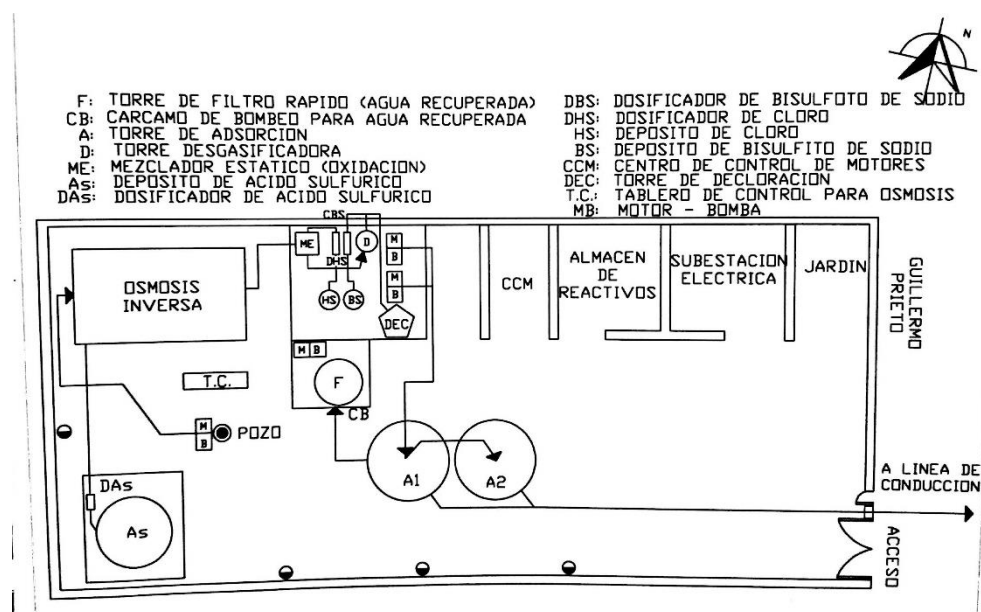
Vista en planta de la PP Santa Catarina 4
